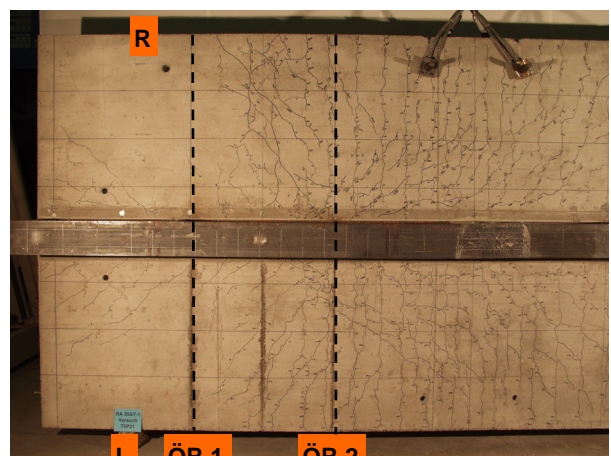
Rissbild auf der Betongurtunterseite
